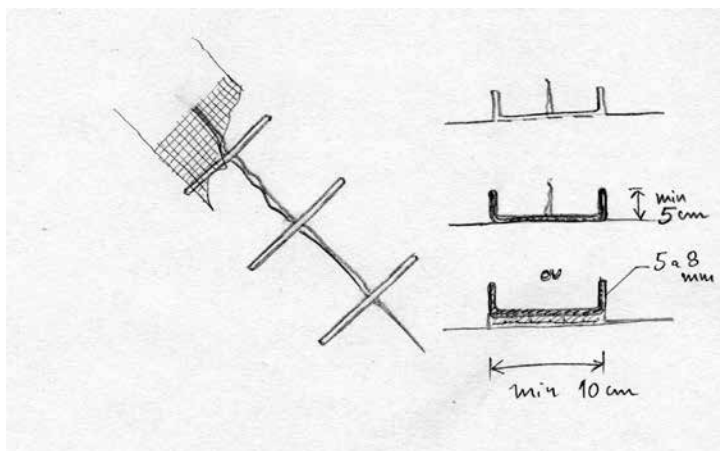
Ilustração esquemática de reabilitação de fissuras - Ficha A3.
